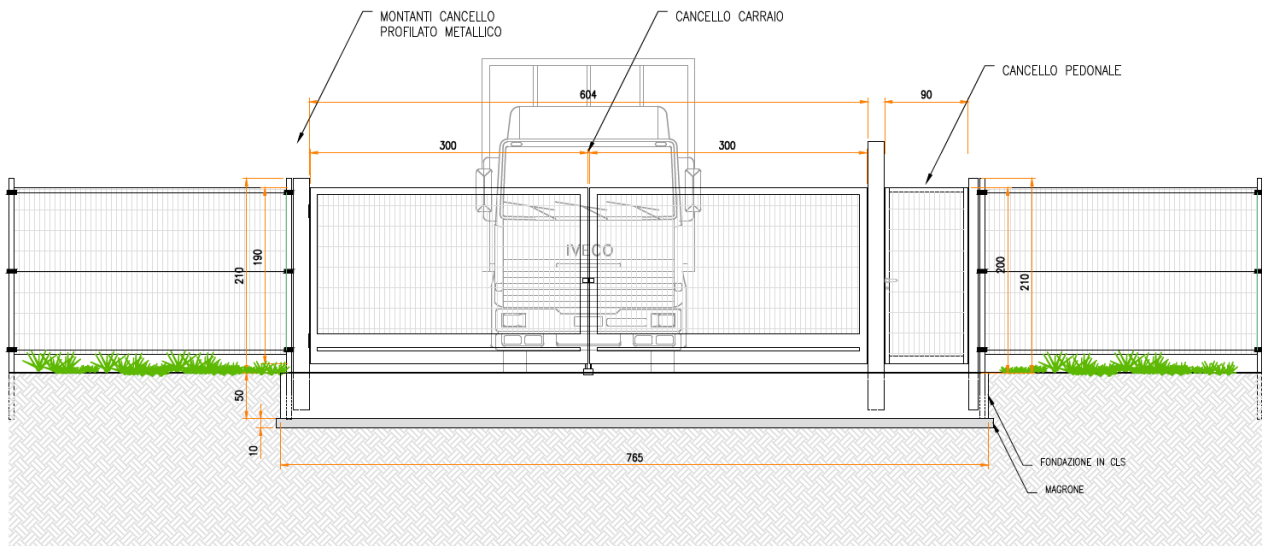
Sezione longitudinale accesso carraio e pedonale
